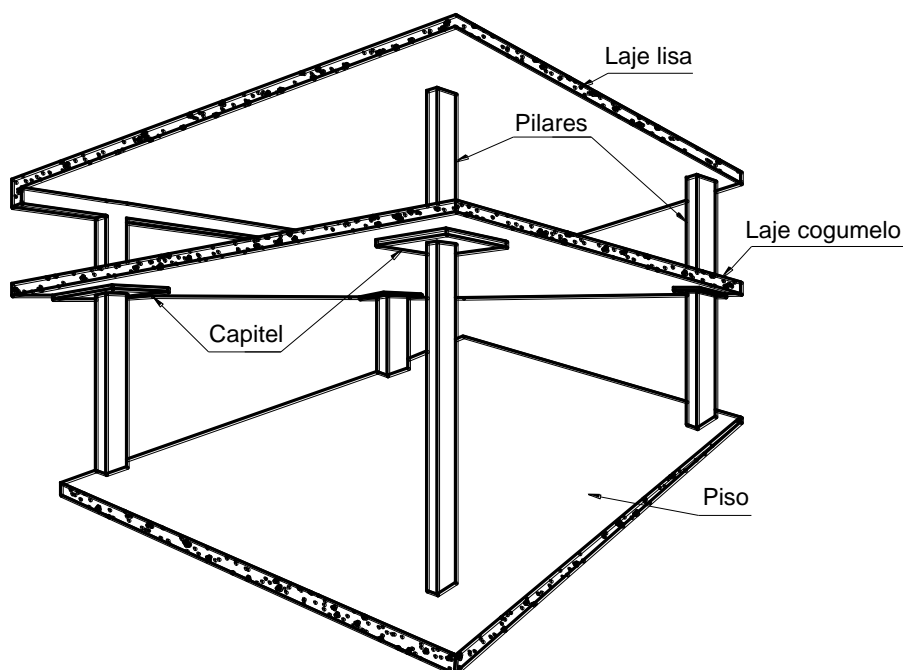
Exemplo de lajes lisa e cogumelo (FONTE: MACGREGOR, 1997).
